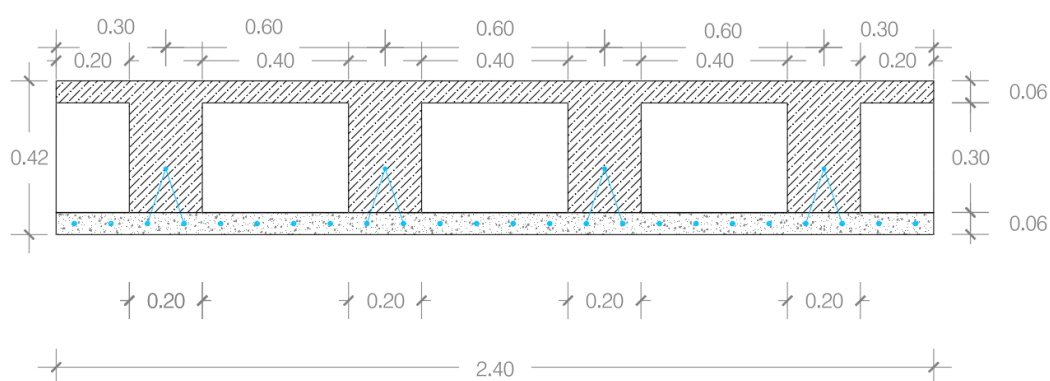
Pré-laje aligeirada simplesmente apoiada
